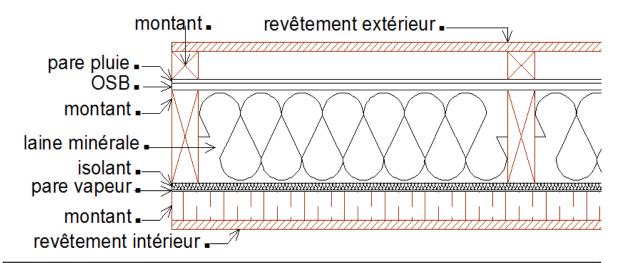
plan détail mur extérieur en bois. Source : auteurs.
